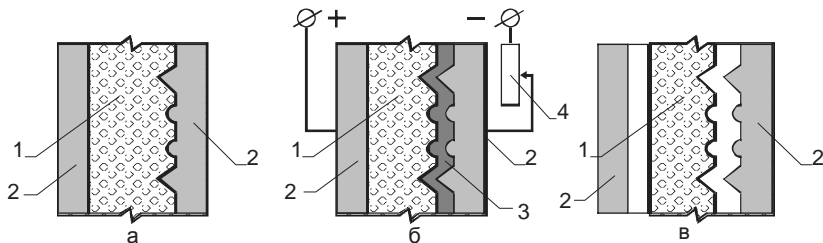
Распалубка с электрообработкой бетонной смеси
